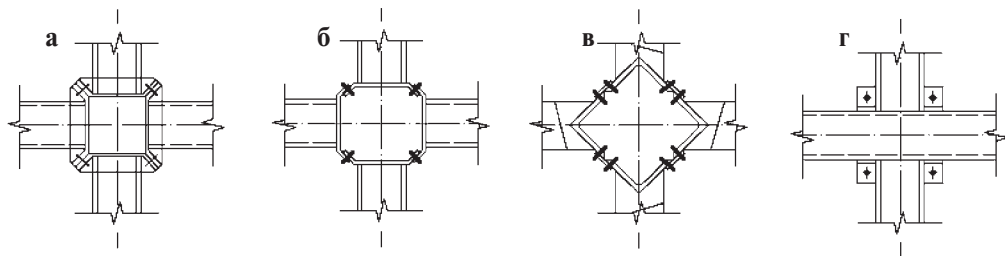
Узлы пересечения перекрестных ферм: а) на гнутых фланцах с диафрагмами жесткости; б) на гнутых фланцах без диафрагм жесткости; в) на фасонных деталях из уголков с листовыми накладками; г) с поэтажным расположением пересекающихся поясов
